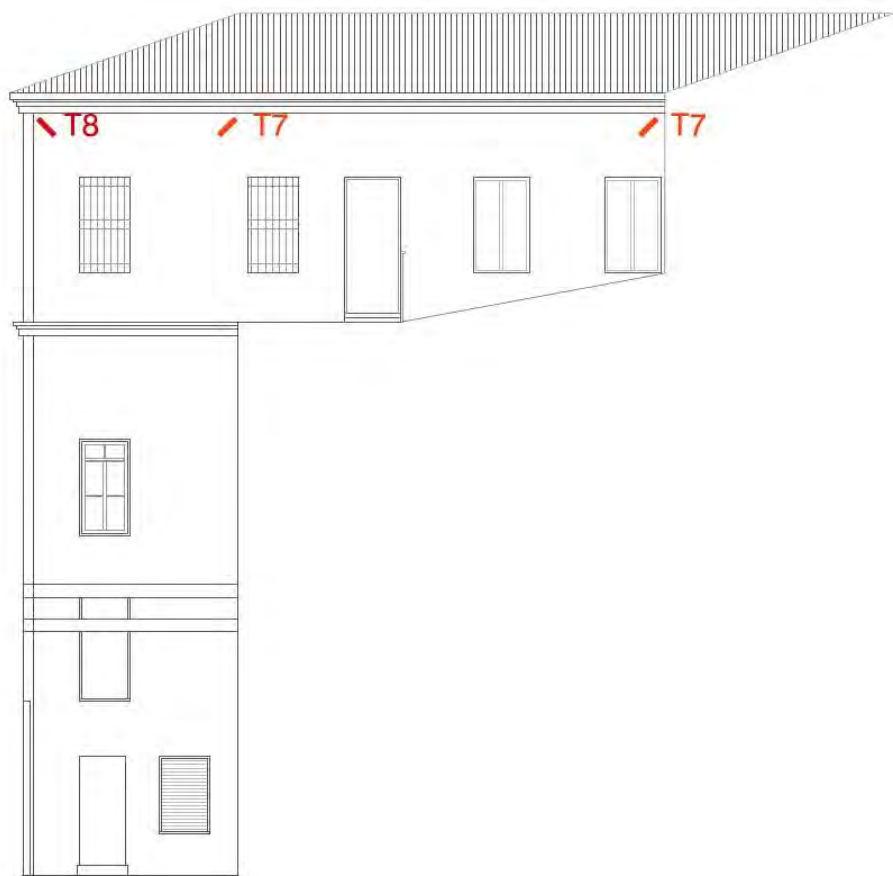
Schematizzazione della posizione dei tiranti, prospetto meridionale
